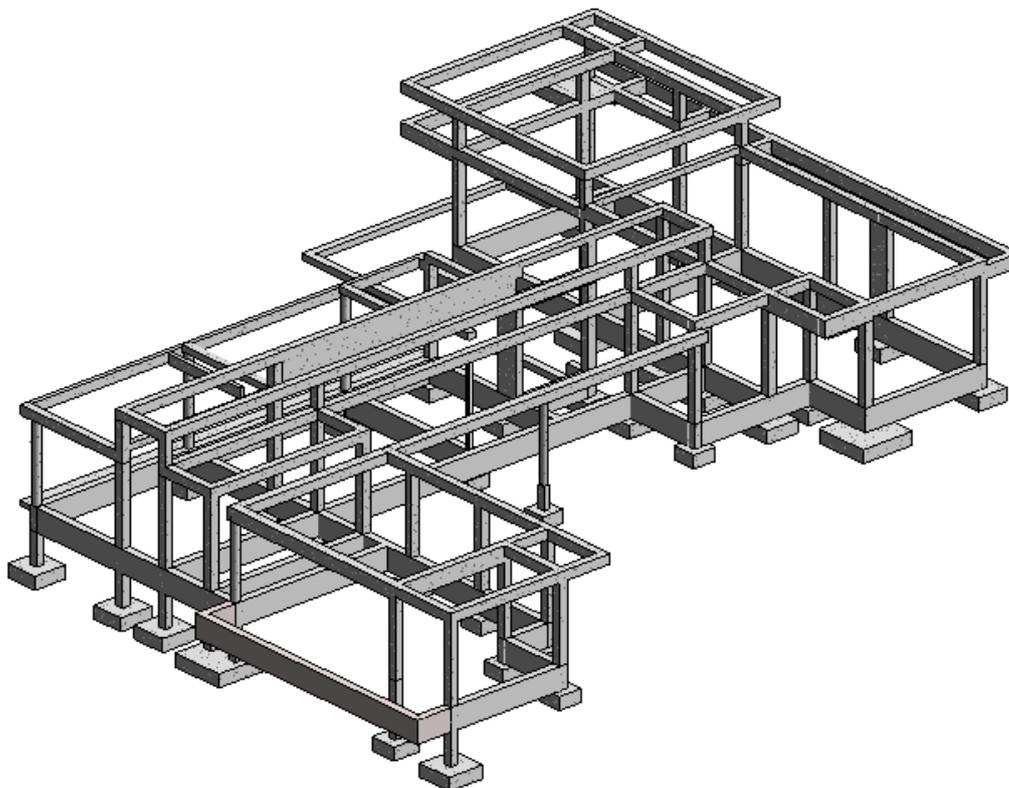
Elementos de fundação e vigas do projeto de execução, Revit
